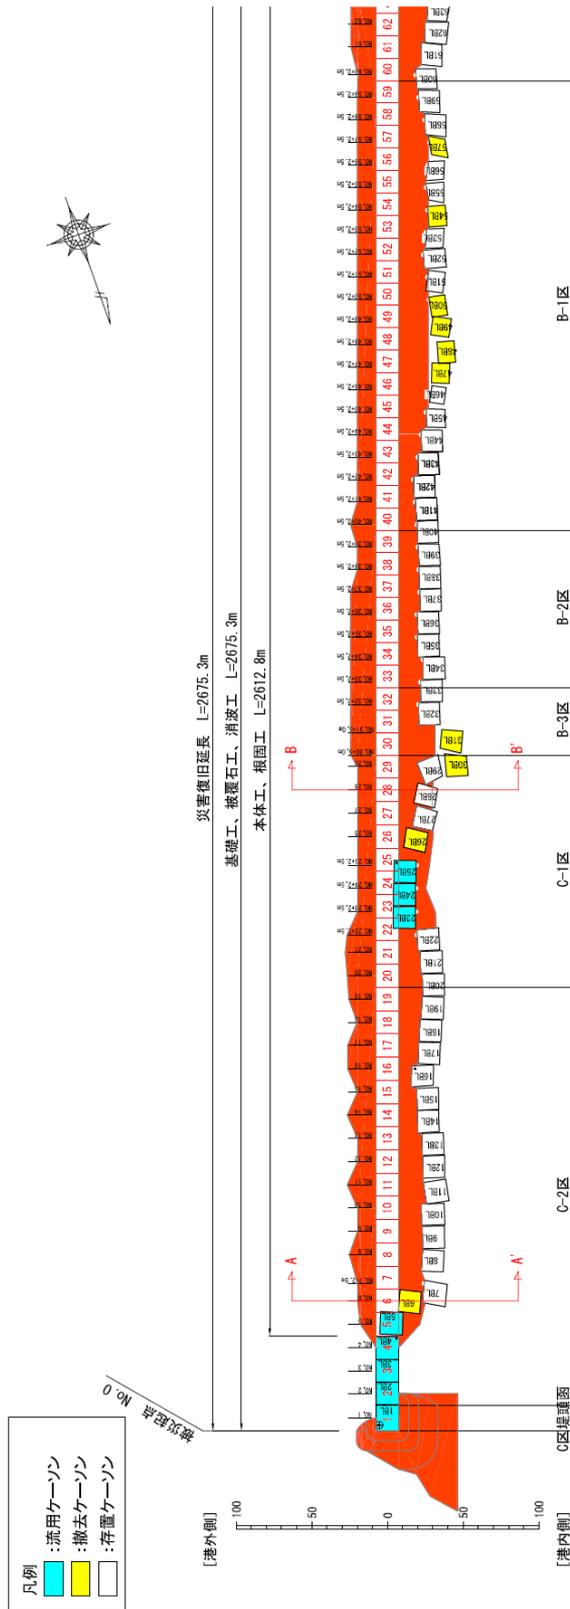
No.1 沖防波堤の平面図 B-1区～C区堤頭 (被災後・復旧後)
